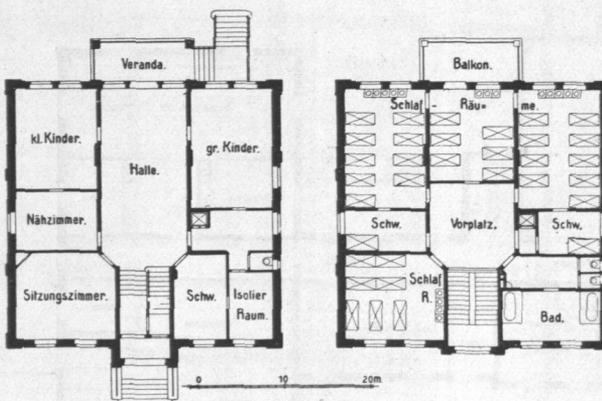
und 614. Borsteler Kinderheim, Erd- und Obergeschoß, Grundriß.
